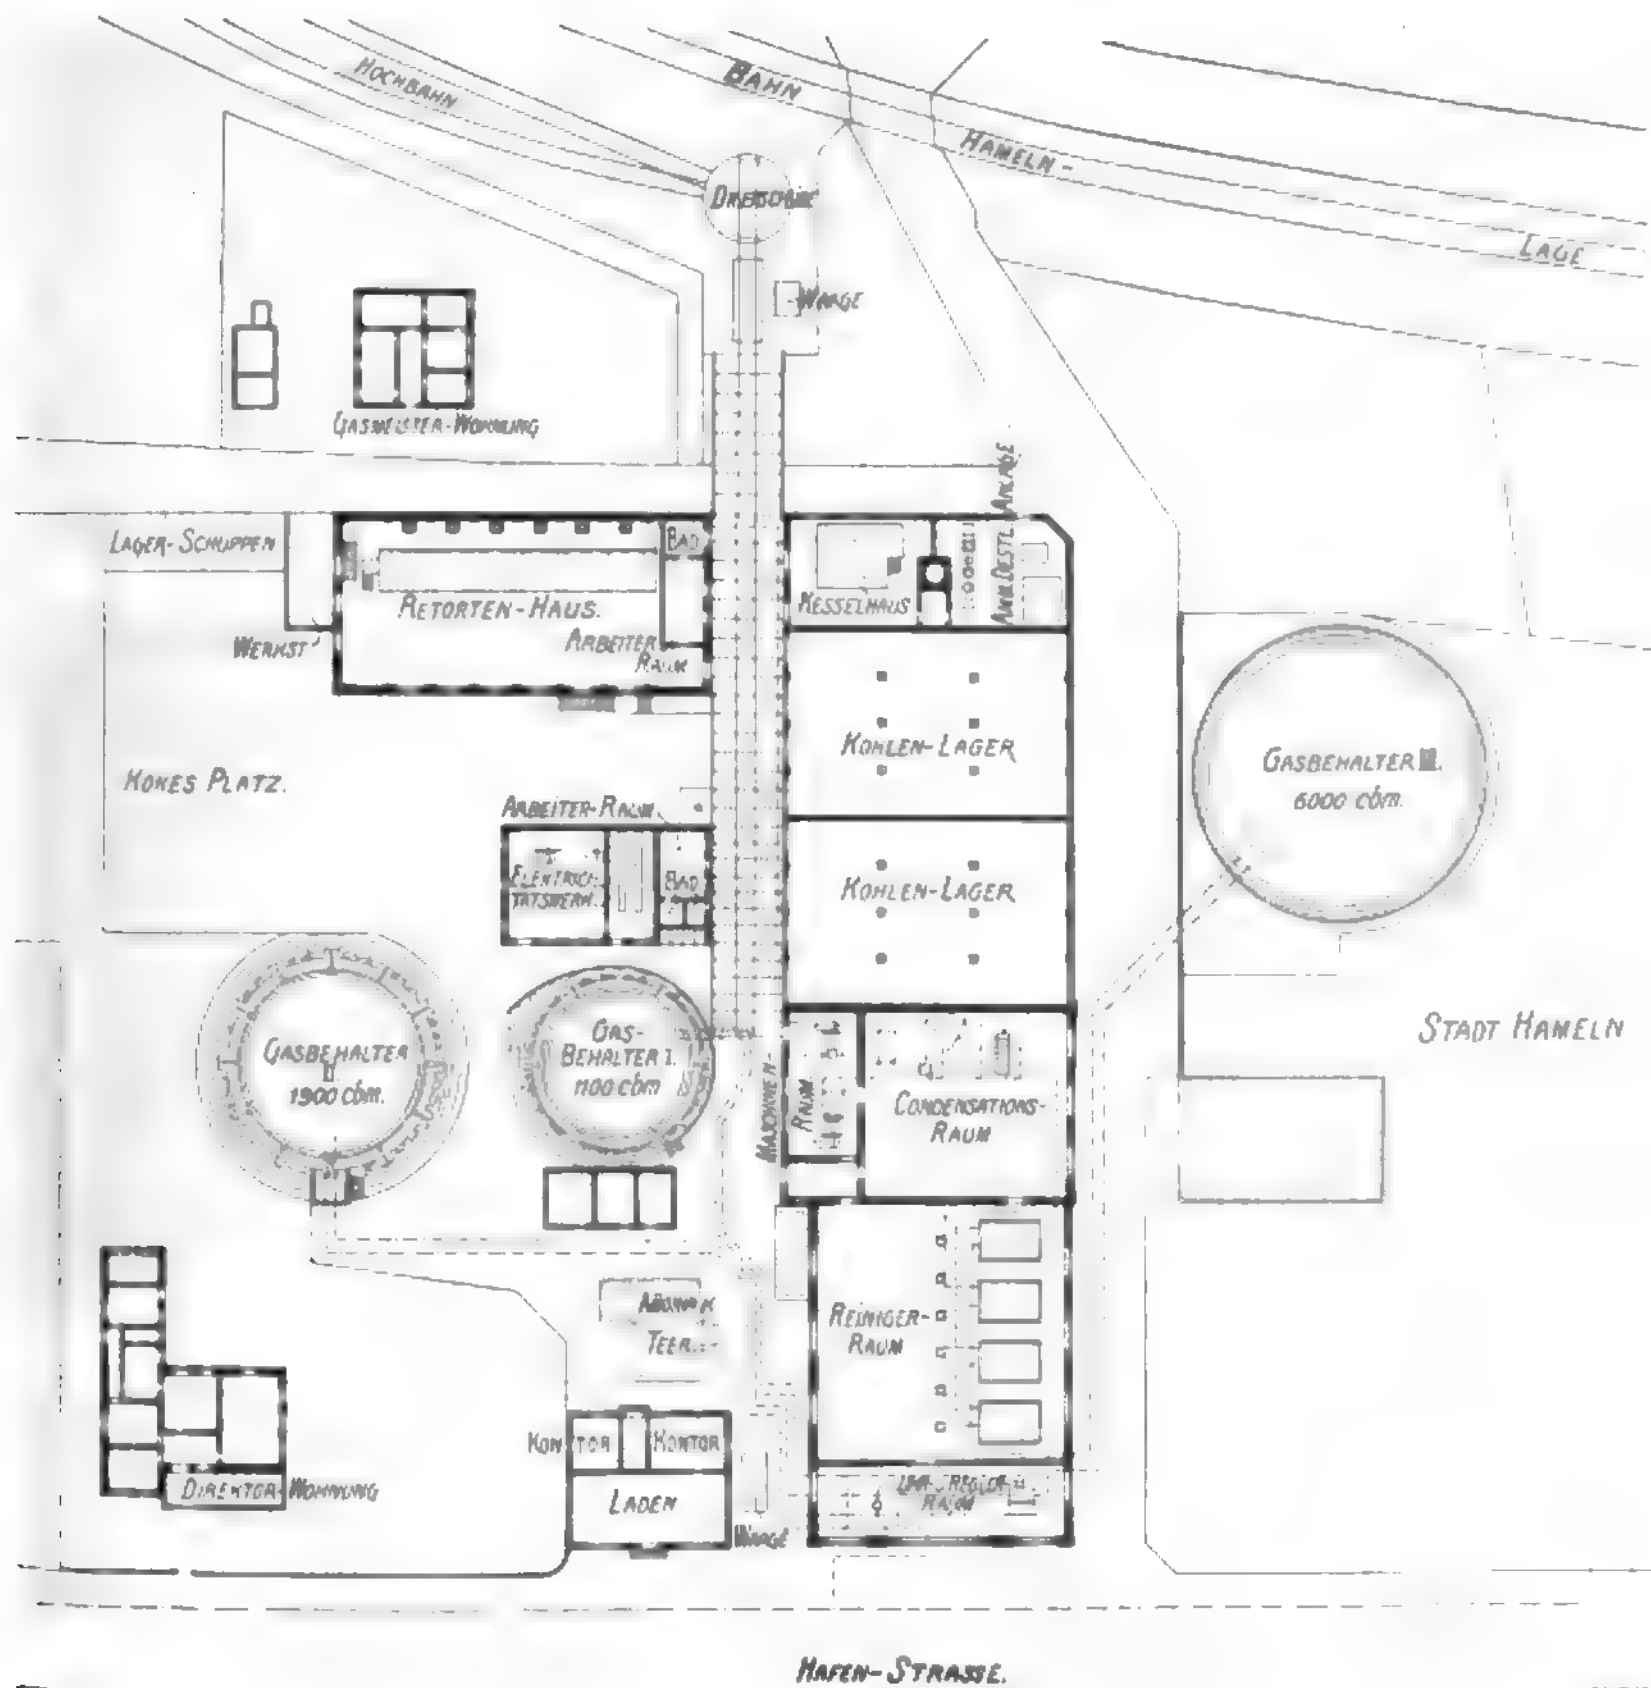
Plan der städtischen Gasanstalt Hameln. Umbau 1902-1906.
